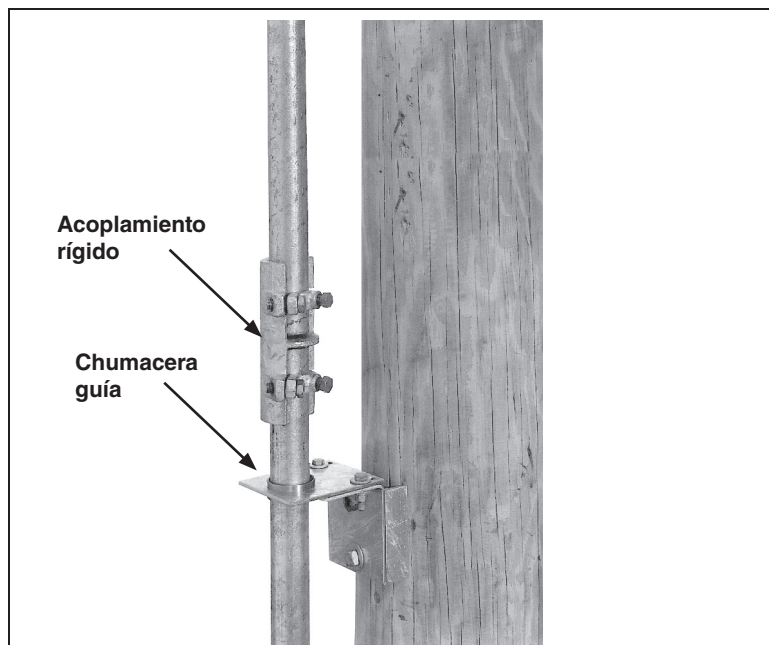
Instalación de la chumacera guía para la sección adicional de tubo.
